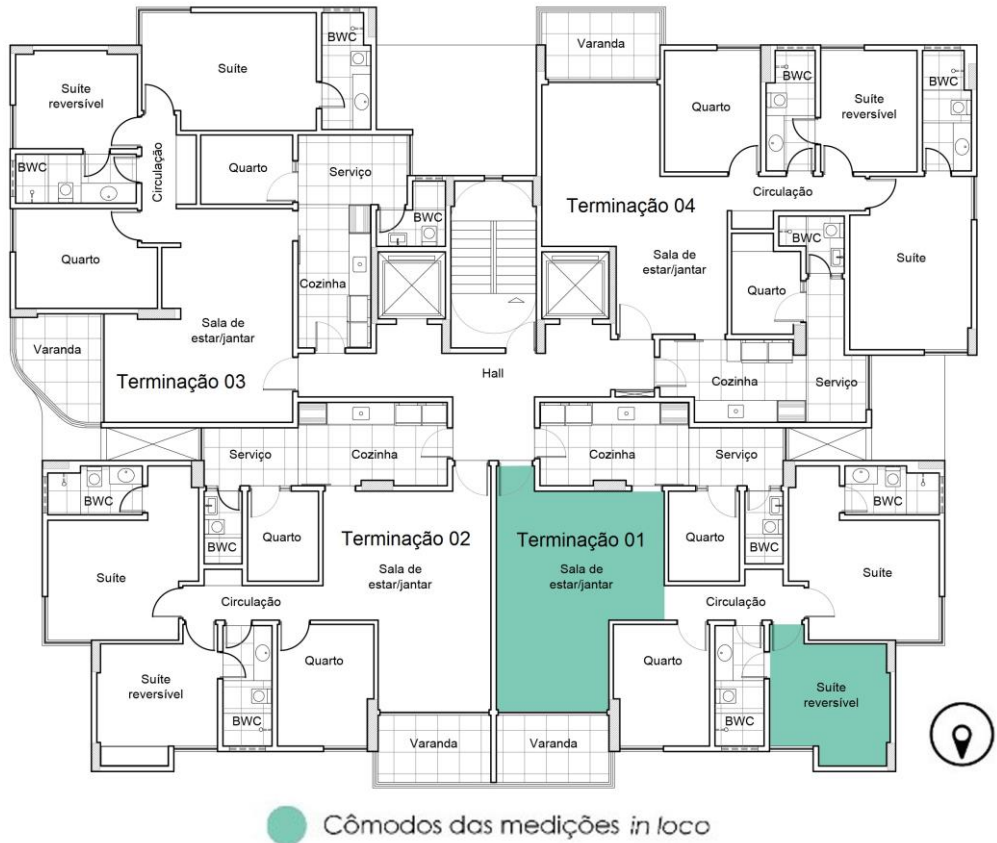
Planta baixa do pavimento tipo do objeto de estudo.
